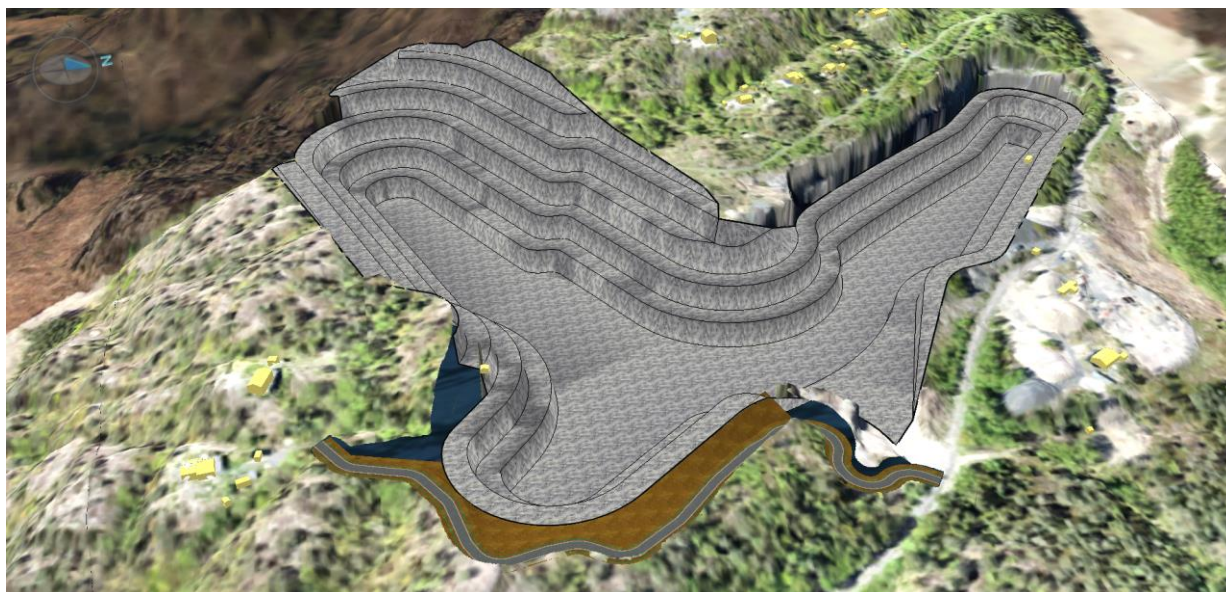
Alternativ 2 (planforslaget) - Fase 4
